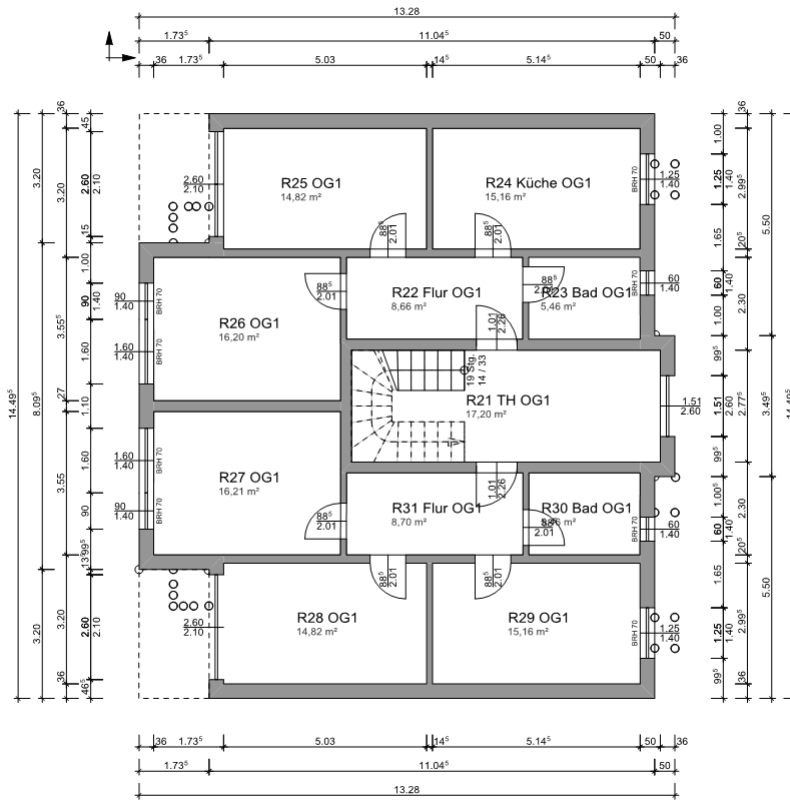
Grundriss 1. Obergeschoss Mehrfamilienhaus
